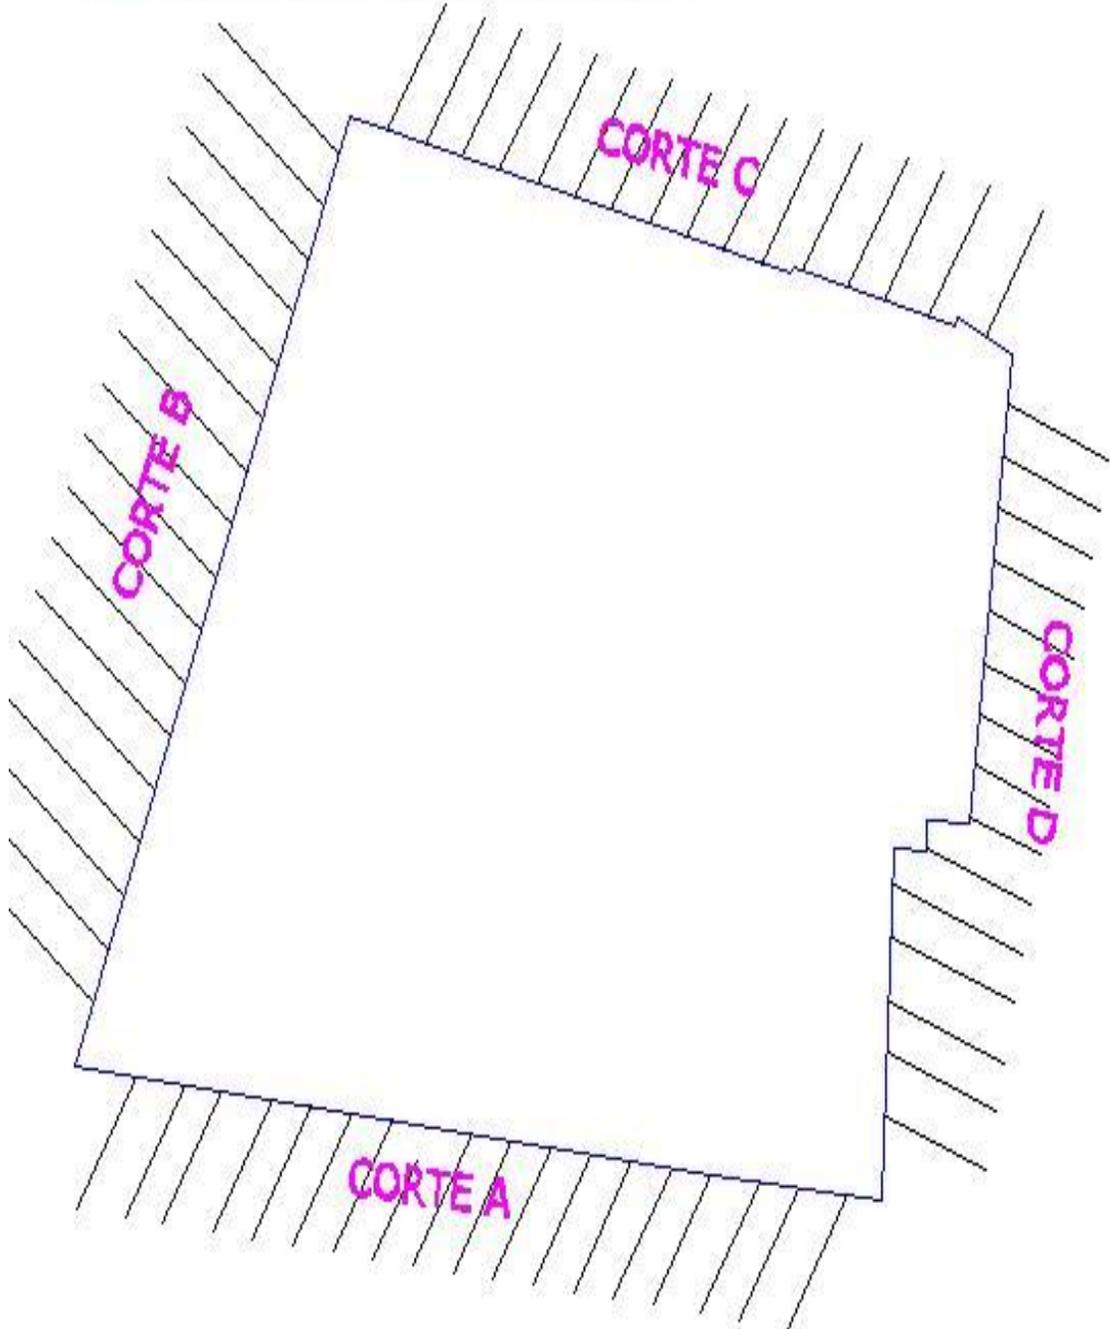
PLANTA ESQUEMATICA DE ANCLAJE
